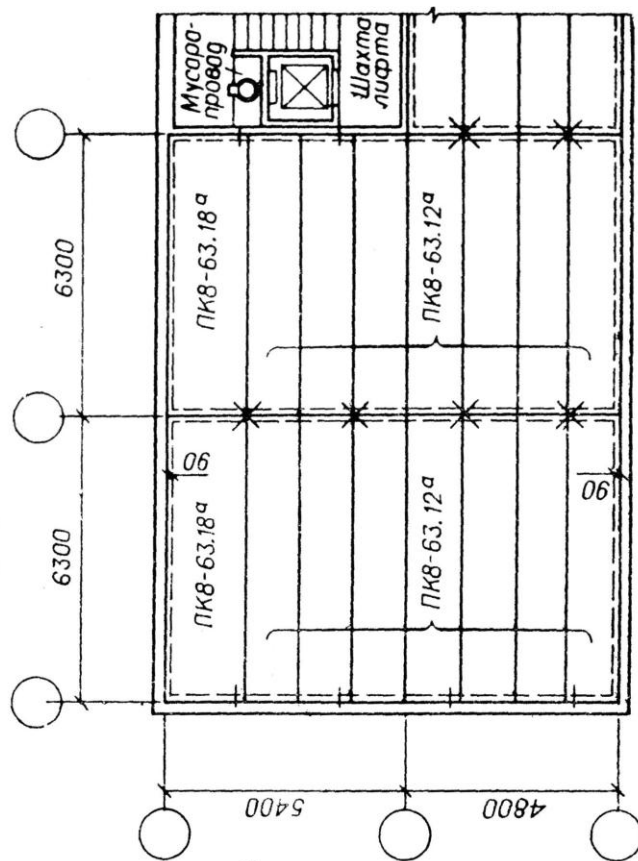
Планы раскладки и анкеровки ж/б плит с круглыми пустотами
